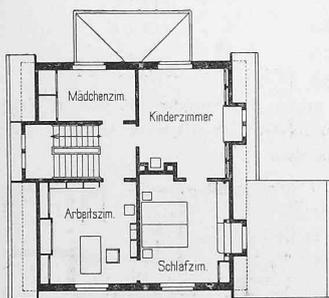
Grundriss vom Obergeschoss des Hauses von Dr. Finckh. — 1:400.
